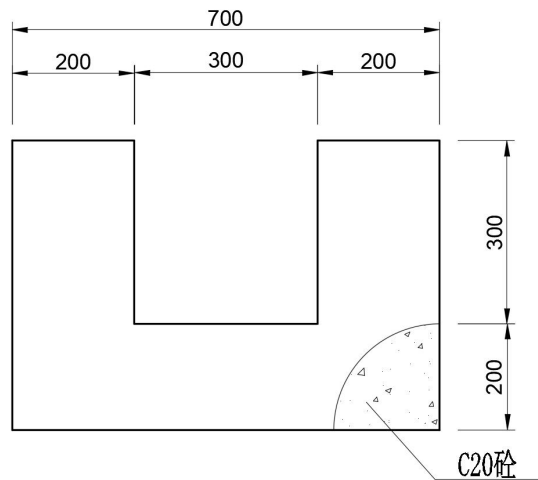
HP03 截排水沟设计断面图（单位 mm）
